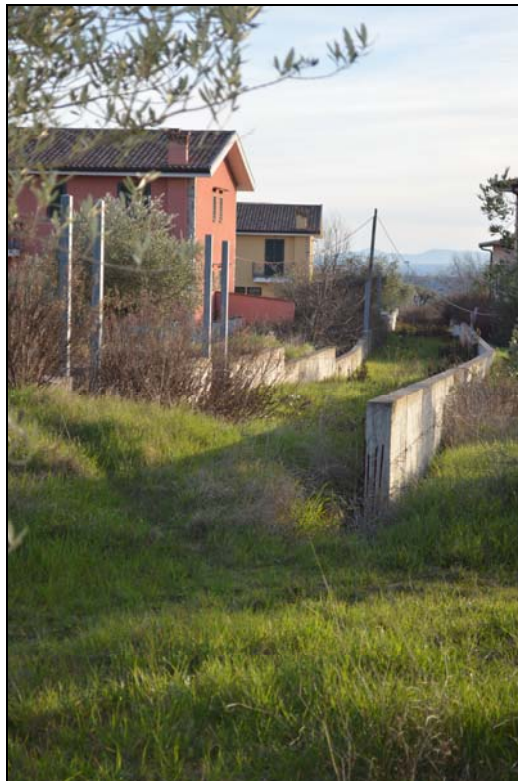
Vialetto interno area Nord-Ovest della lottizzazione
